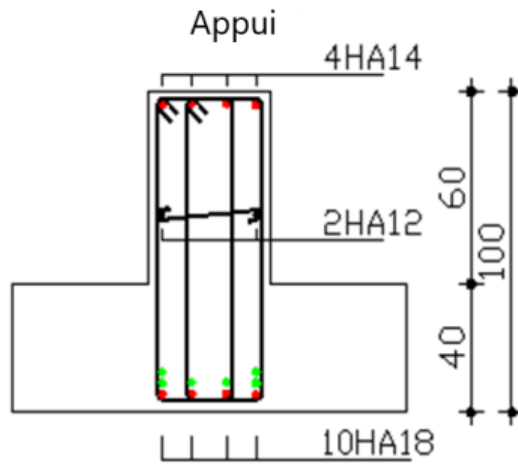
Ferrailage de la poutre secondaire en appui
